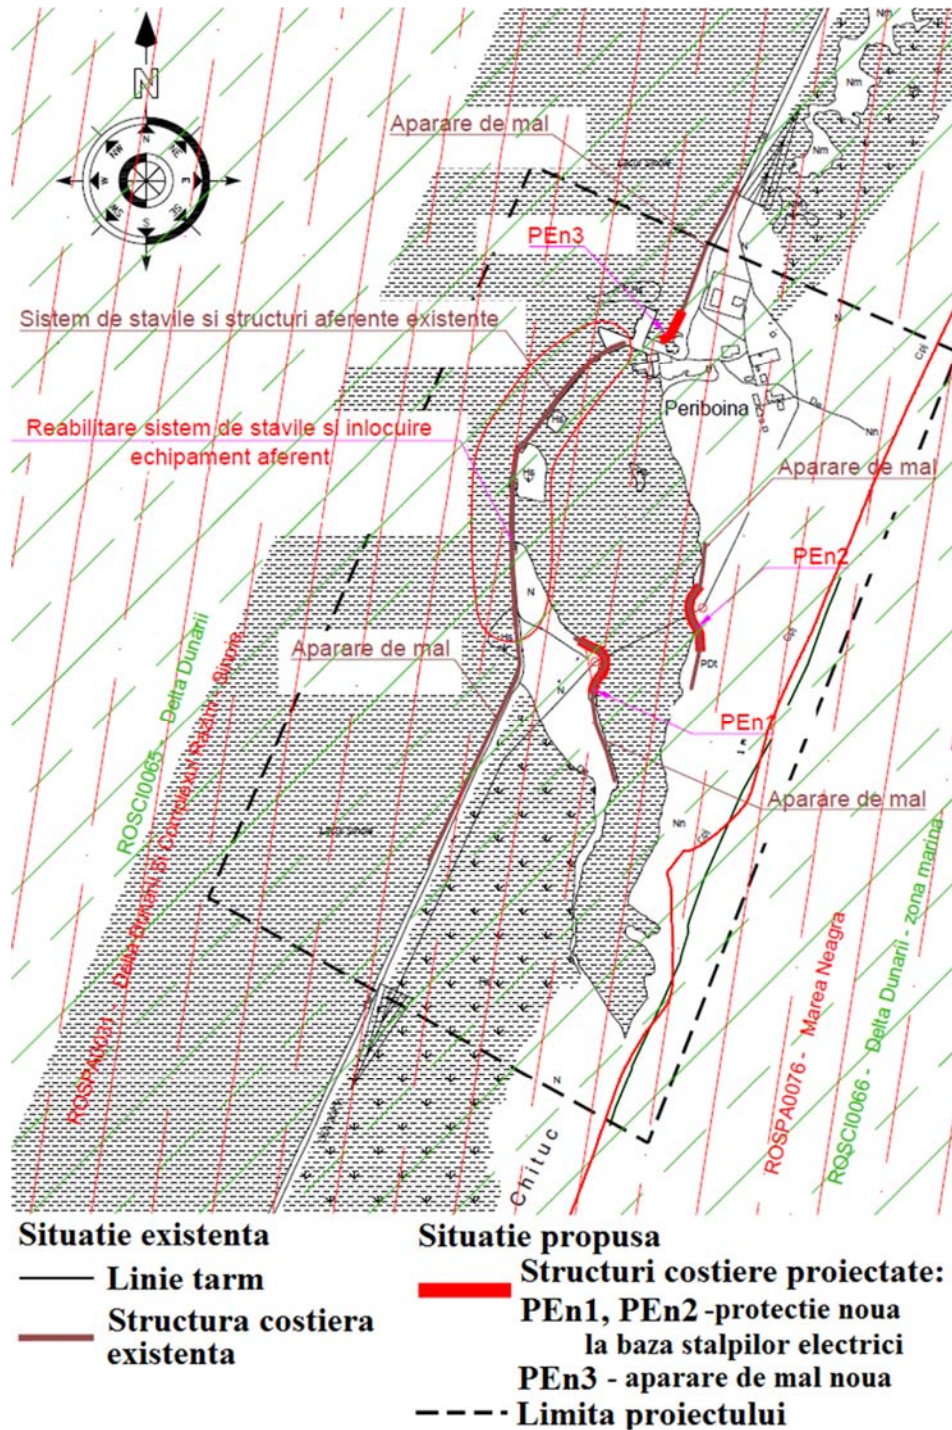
6 - Prezentare în plan a situației existente și situației proiectate din zona Stavilare (stavilar Periboina)
